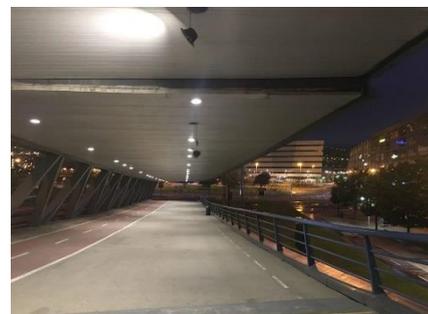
Escalón en la cubierta. Fuente: cope.es
